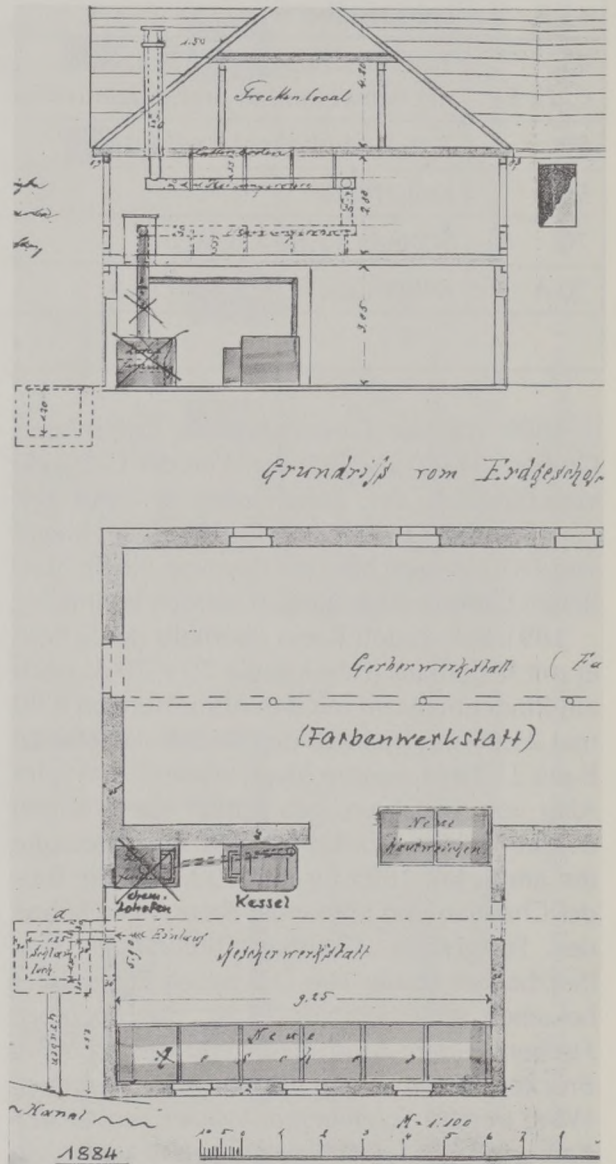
Grundriss und Schnitt von dem 1873/74 errichteten Anbau am Gerbereigebäude 622 (Fabrikstraße 43) mit der veränderten Einrichtung von 1884.
